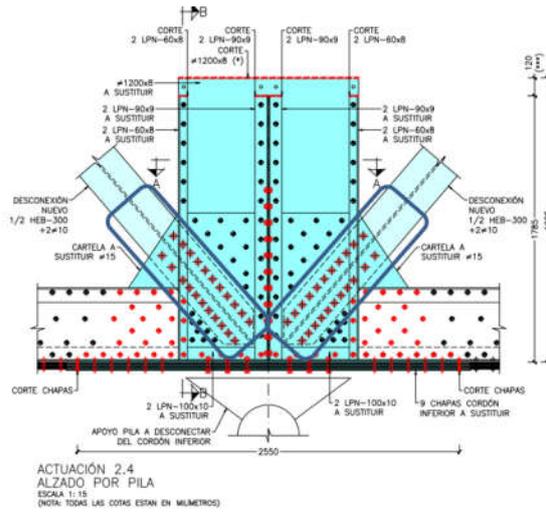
Nudo inferior mamparo de pila. Desatornillado de diagonales
